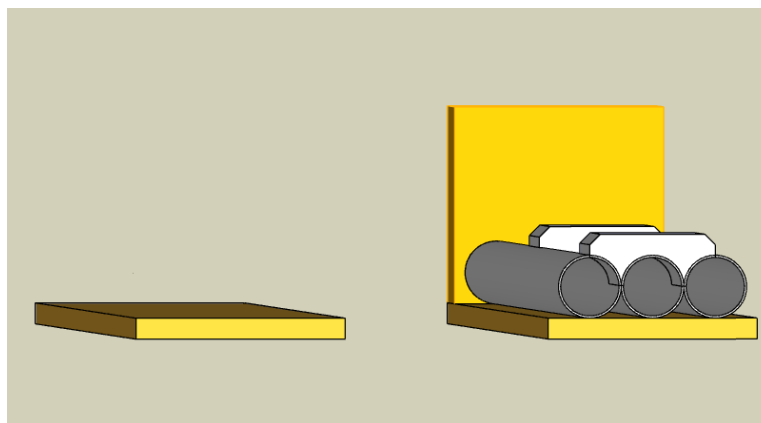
Primeras etapas de la fase constructiva. Lecho de arena y colocación de entubado.
